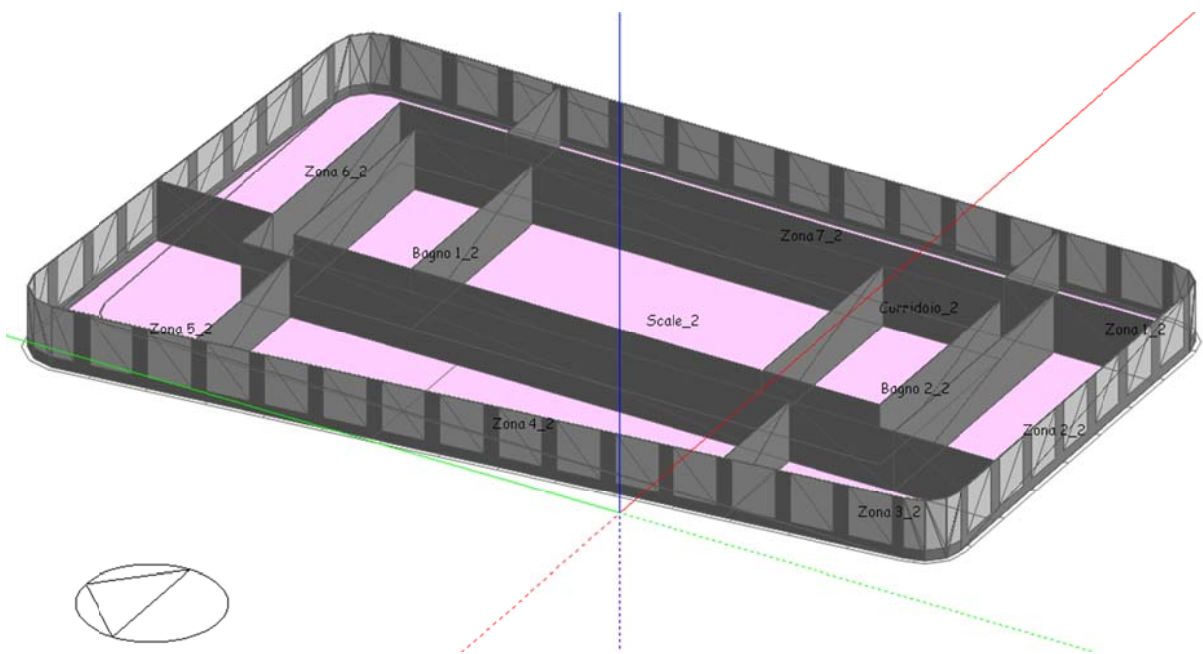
Vista assometrica della tipologia B di piano tipo.
